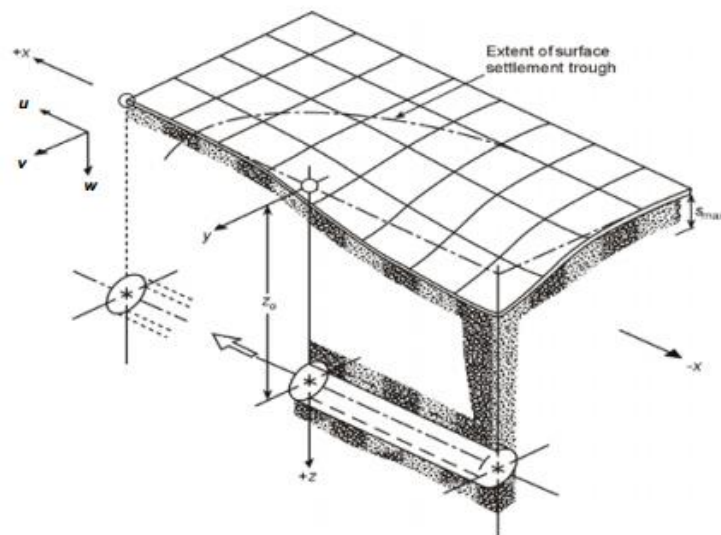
3 Geometría de asentamientos inducida por la excavación de un túnel. (Attewell y Yeates et al., 1986)
